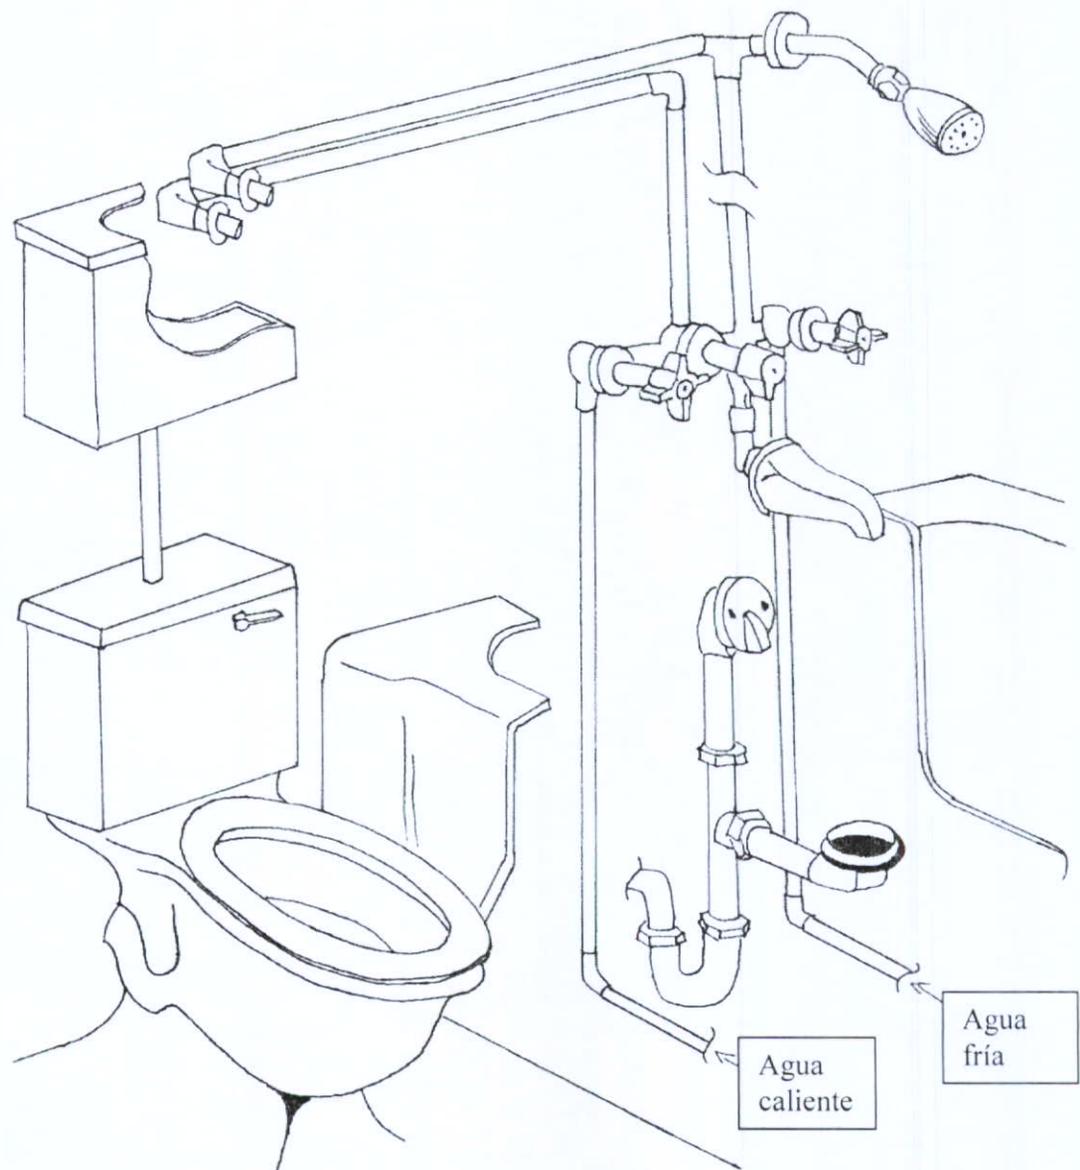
Instalación del dispositivo, para adaptarse a un baño ya construido.
